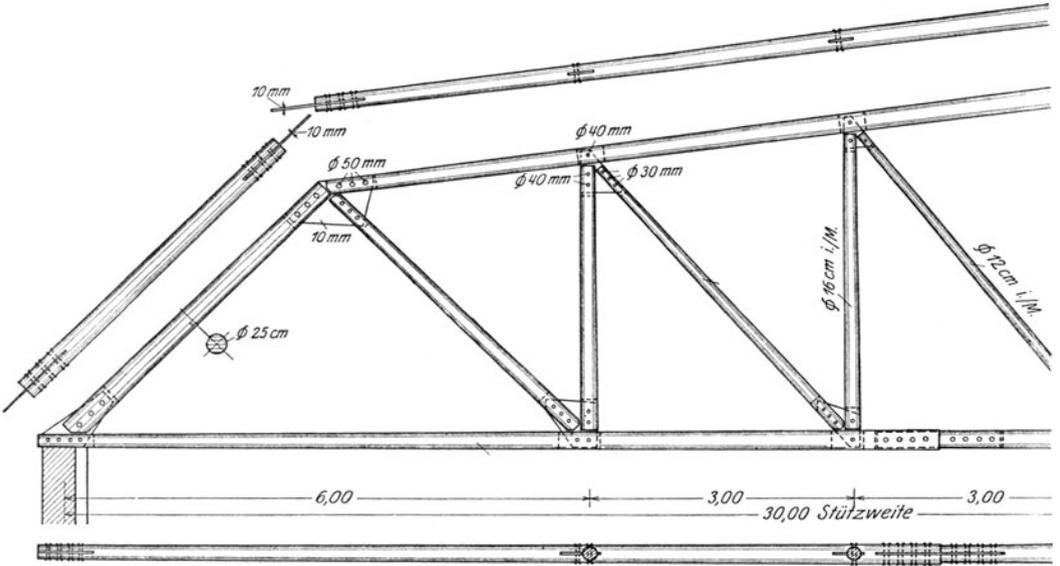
Fachwerkbinder in Rundholz mit eisernen Knotenblechen.
